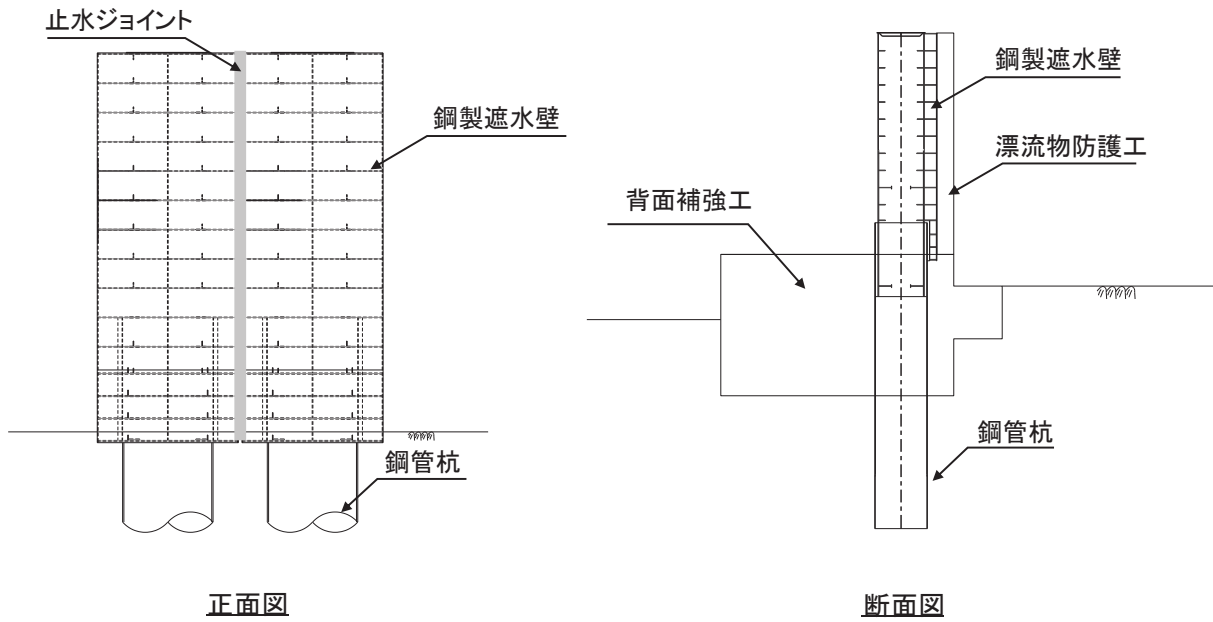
10. 2-25 鋼管式鉛直壁（岩盤部） 正面図及び断面図（Ⅰ区間）
